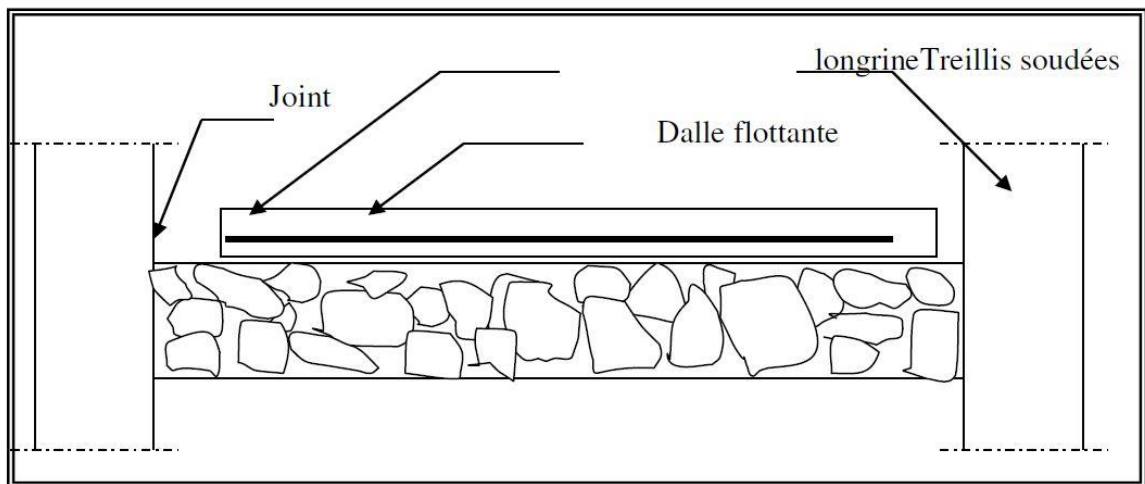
schéma de ferrailage de la dalle flottante.
